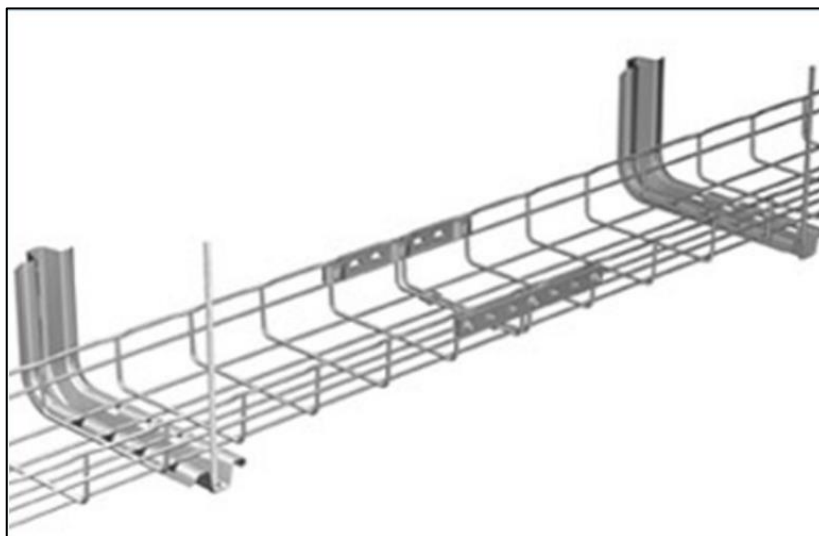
BANDEJA CONDUIT PORTA CABLES
